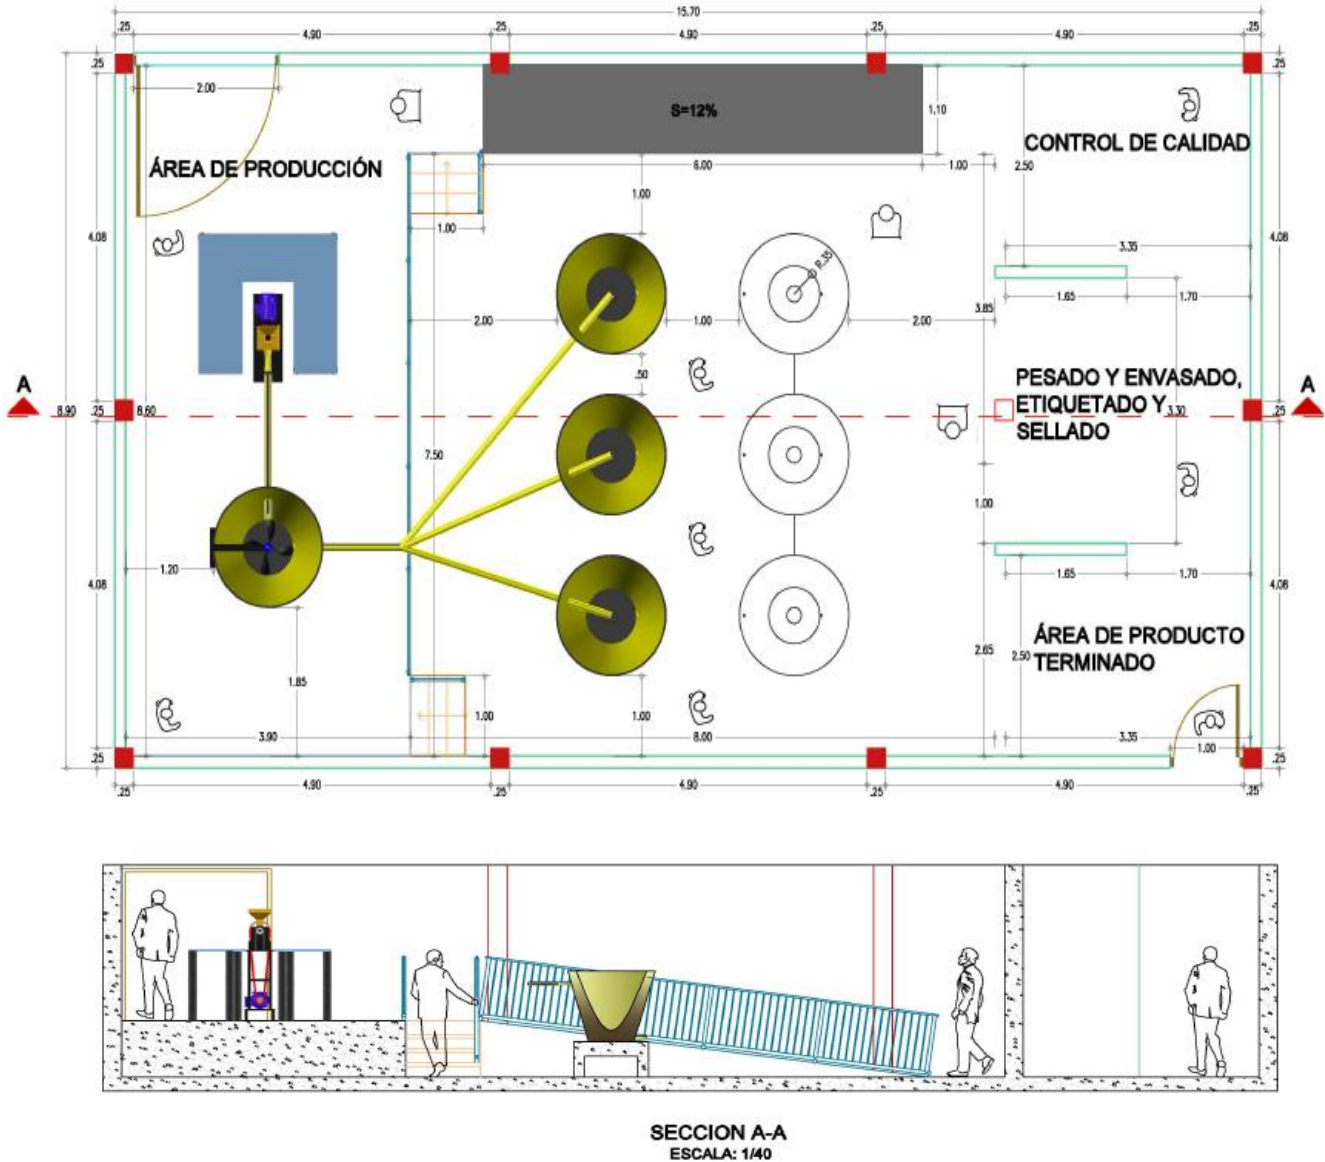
Diseño de planta en AUTOCAD – Vista de Corte del Diseño de la Planta
